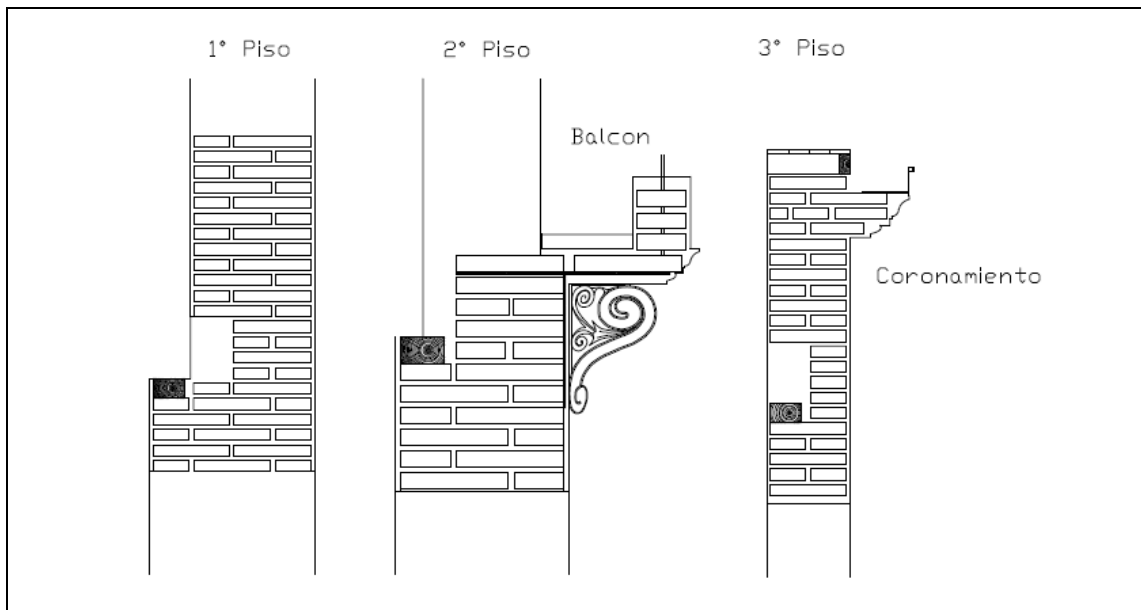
Detalle del apoyo de sistema de piso en los muros de las fachadas (Taller Intramuros, 2007).
